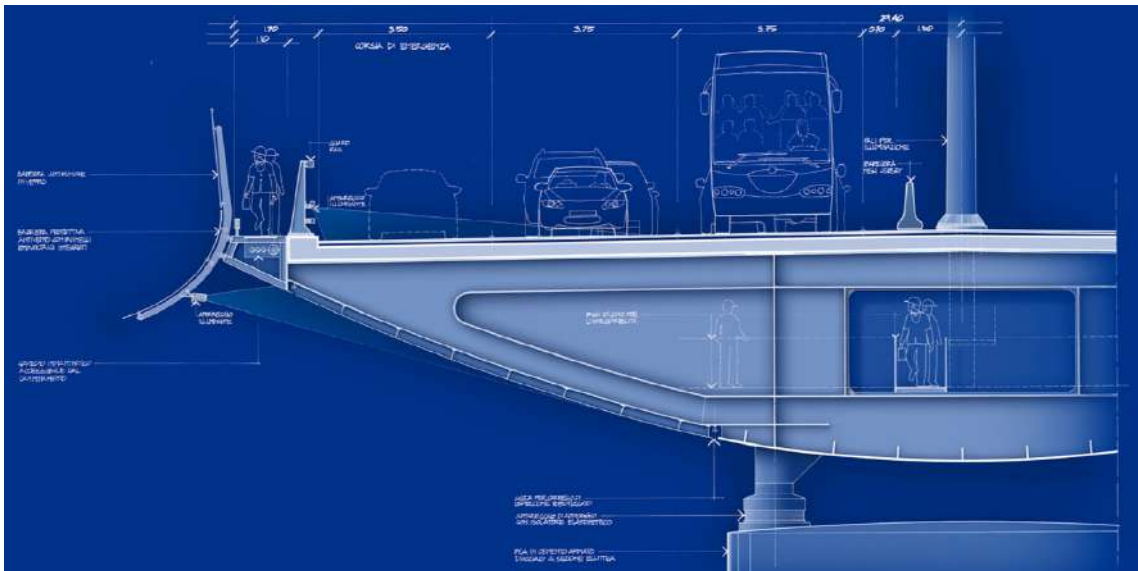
Corte transversal do tabuleiro, proposta preliminar do arquiteto Renzo Piano. Fonte: Renzo Piano Building Workshop
